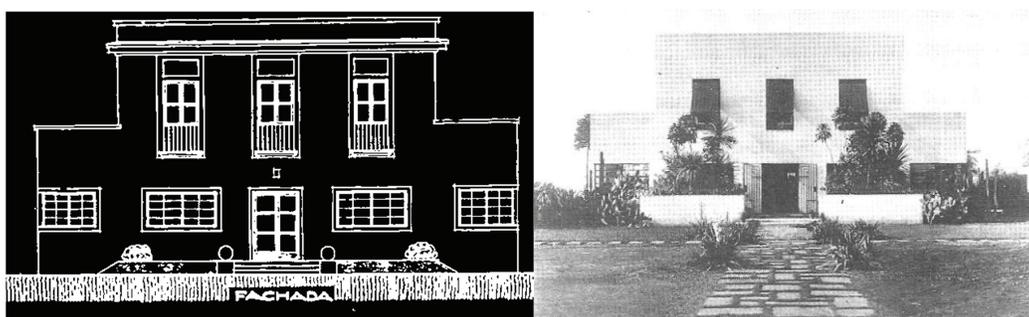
Casa modernista de Gregori Warchavchik de 1927 na Rua Santa Cruz – Fachada aprovada no serviço de censura e fachada executada.
